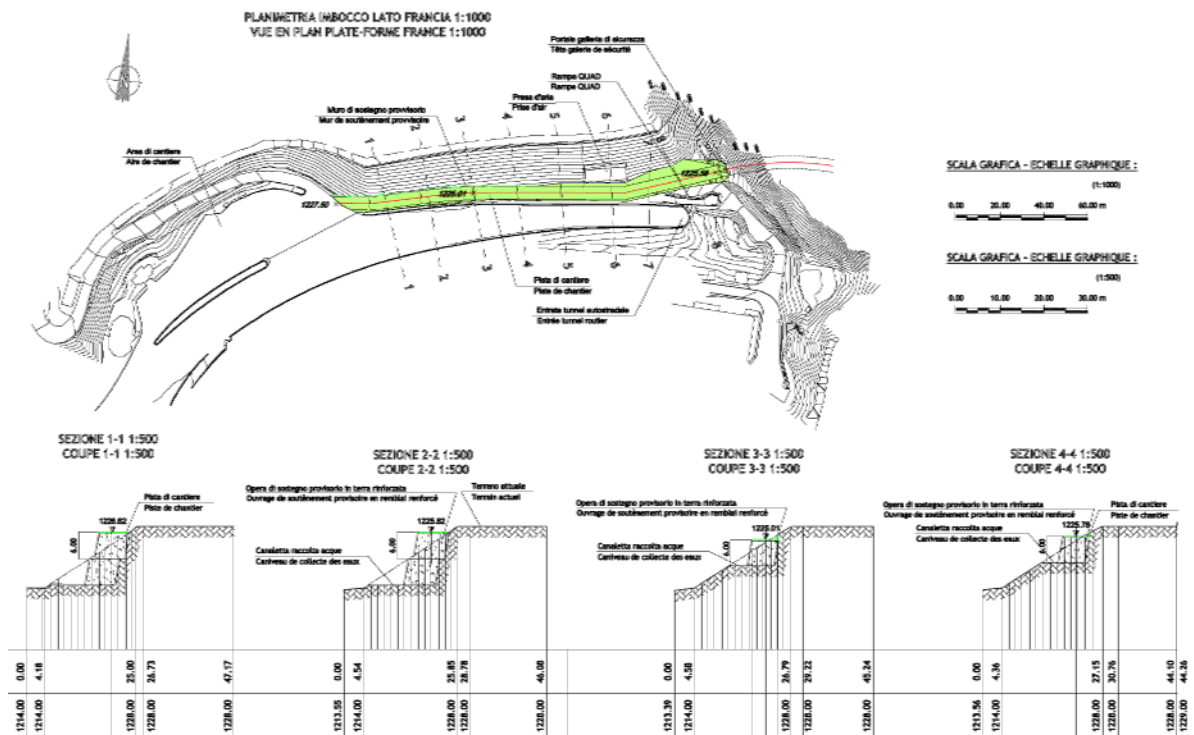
Pista di cantiere: pianta e sezioni (documento 6145.2-P-35)
